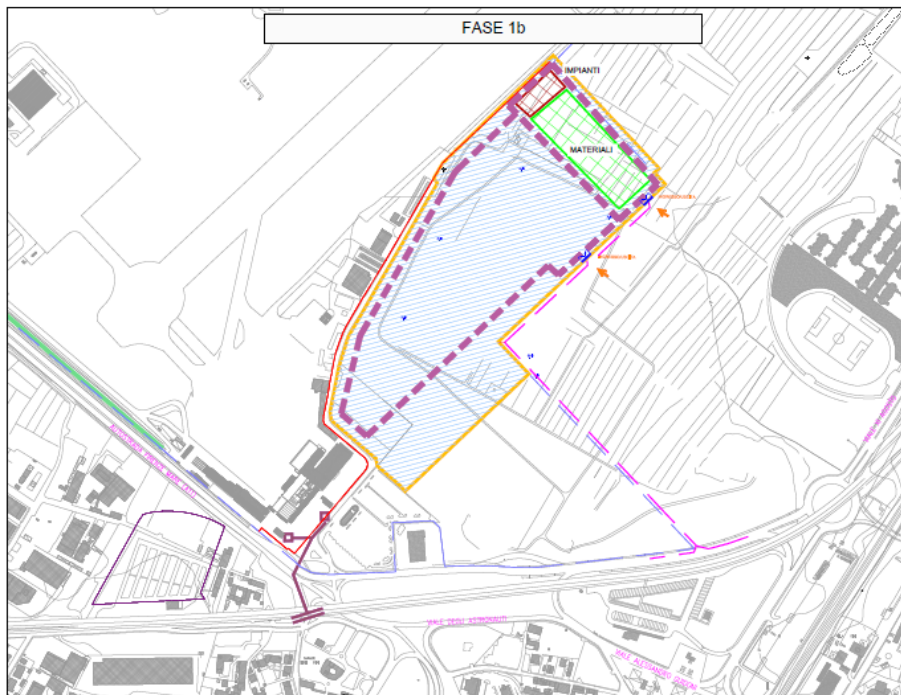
Cantierizzazione dell'Area Nuovo Terminal – Fase 1b
